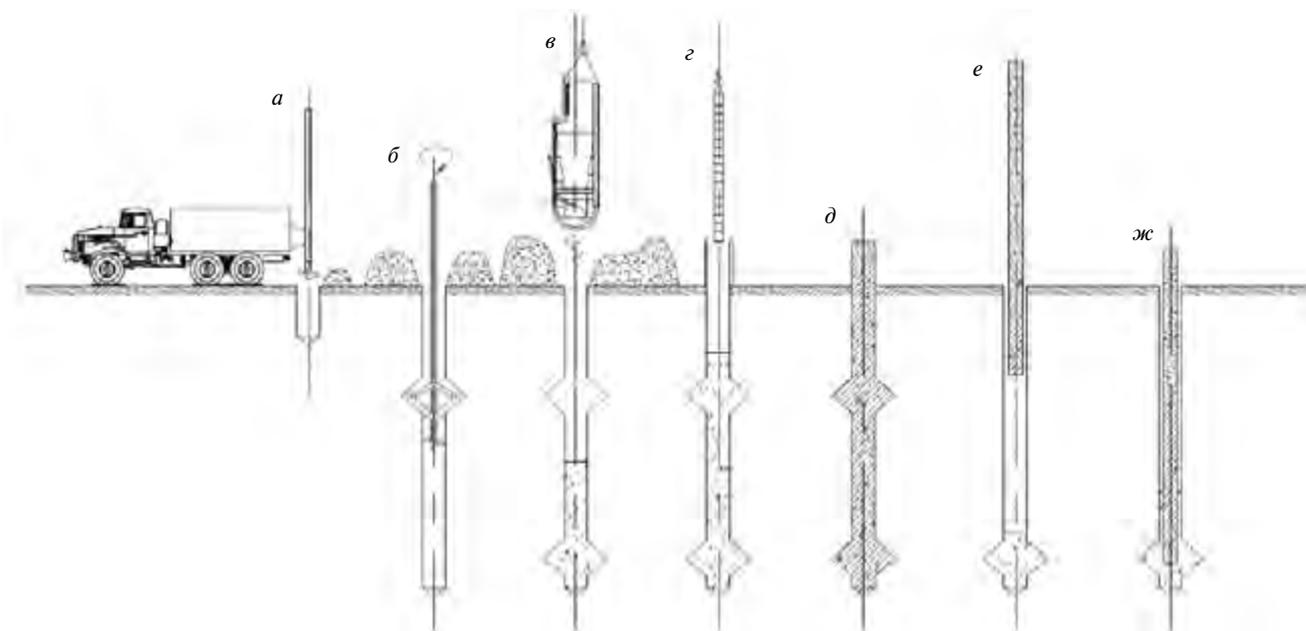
Схема производства работ при устройстве набивных свай с уширениями: а — выбуривание скважины; б — разбуривание уширений и удаление грунта; в — осмотр готовой скважины и бетонирование; г — монтаж армокаркаса; д — бетонирование верха сваи; е — монтаж сборной сваи; ж — сборно-моноклитная свая [13]
